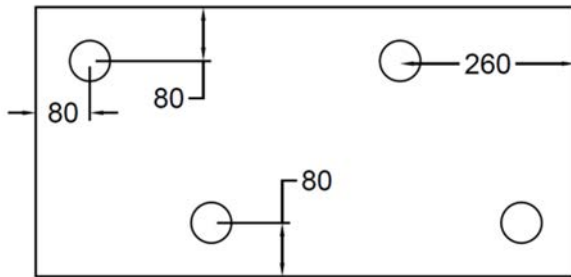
Plans de chevillage - panneaux PAVAWALL-BLOC de dimensions 400 x 600 mm
